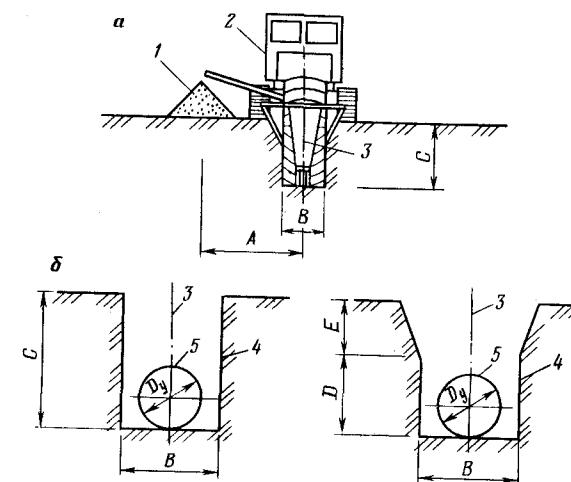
Схема разработки траншеи роторным экскаватором:
